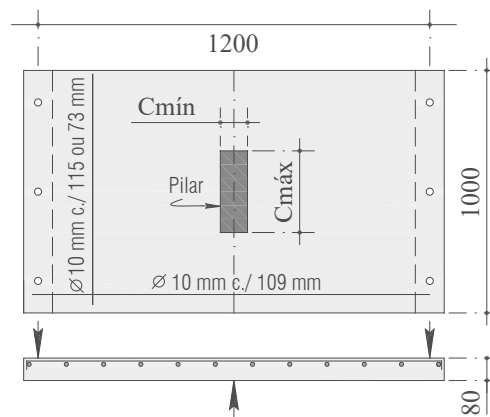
Sistema de ensaio e armaduras das lajes ([VILHENA *et al.*, 2006](#))
